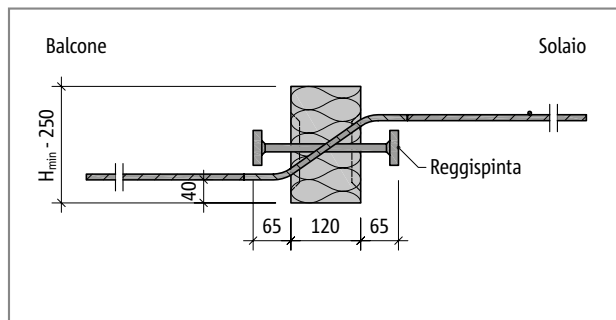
Schöck Isokorb® tipo QPXT: sezione dell'elemento
